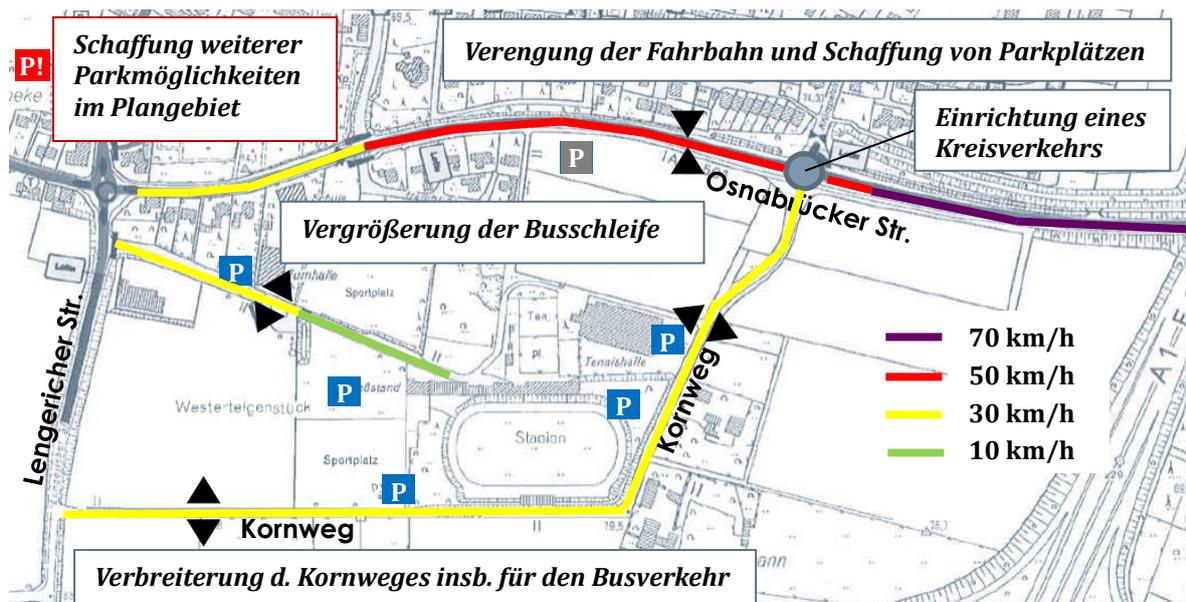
Maßnahmen Verkehr (auf Grundlage von pbh – Planungsbüro Hahm GmbH 2008, geändert durch planinvent 2018)
